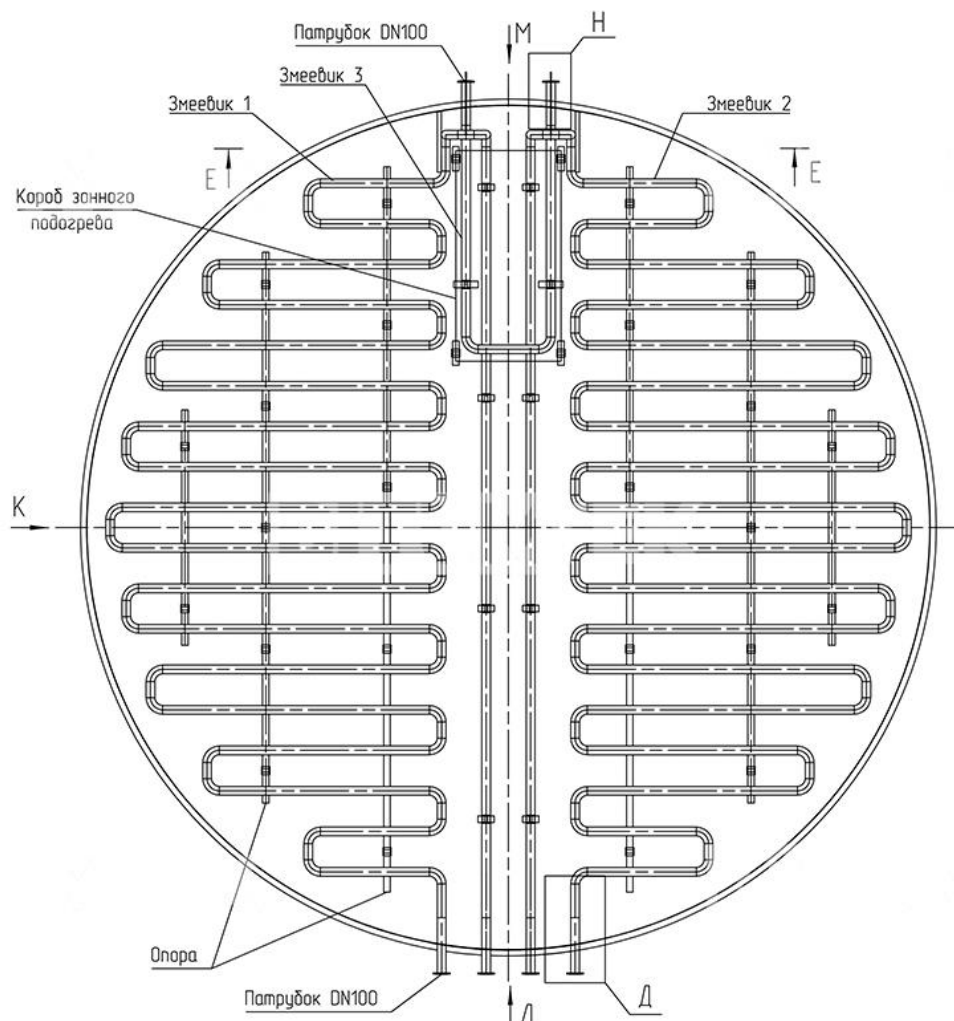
Схема трубных подогревателей резервуара змеевикового типа [15]
